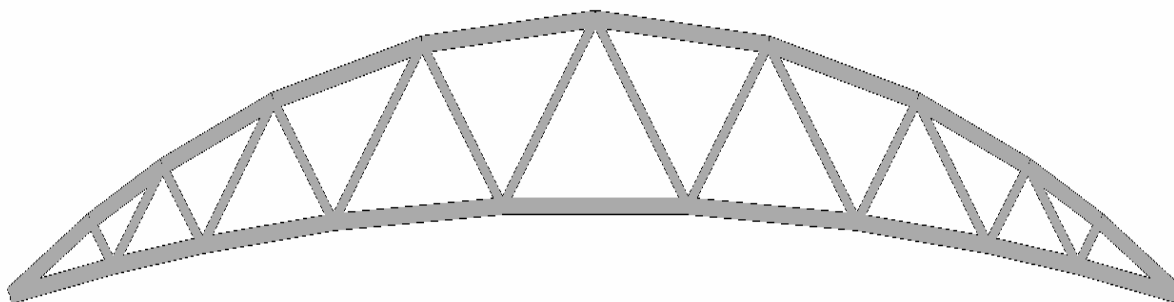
Геометрическая схема линзообразной сегментной фермы с впарушенным нижним поясом
